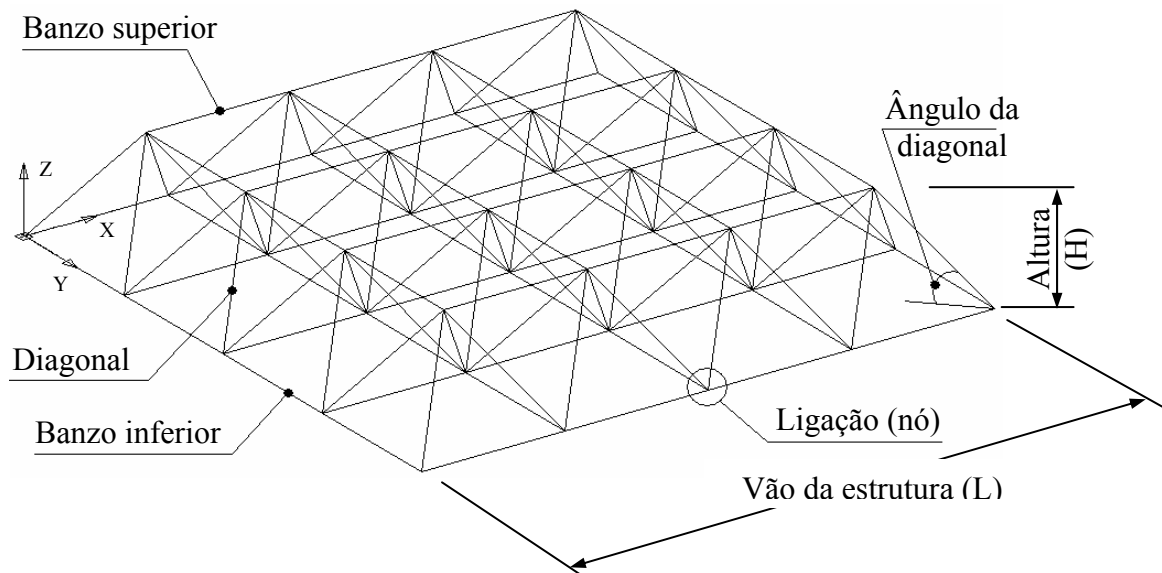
Elementos da estrutura espacial quadrado sobre quadrado
